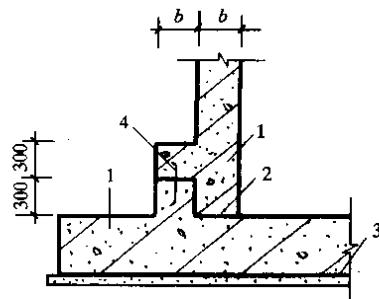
不同强度等级混凝土施工缝示意图
